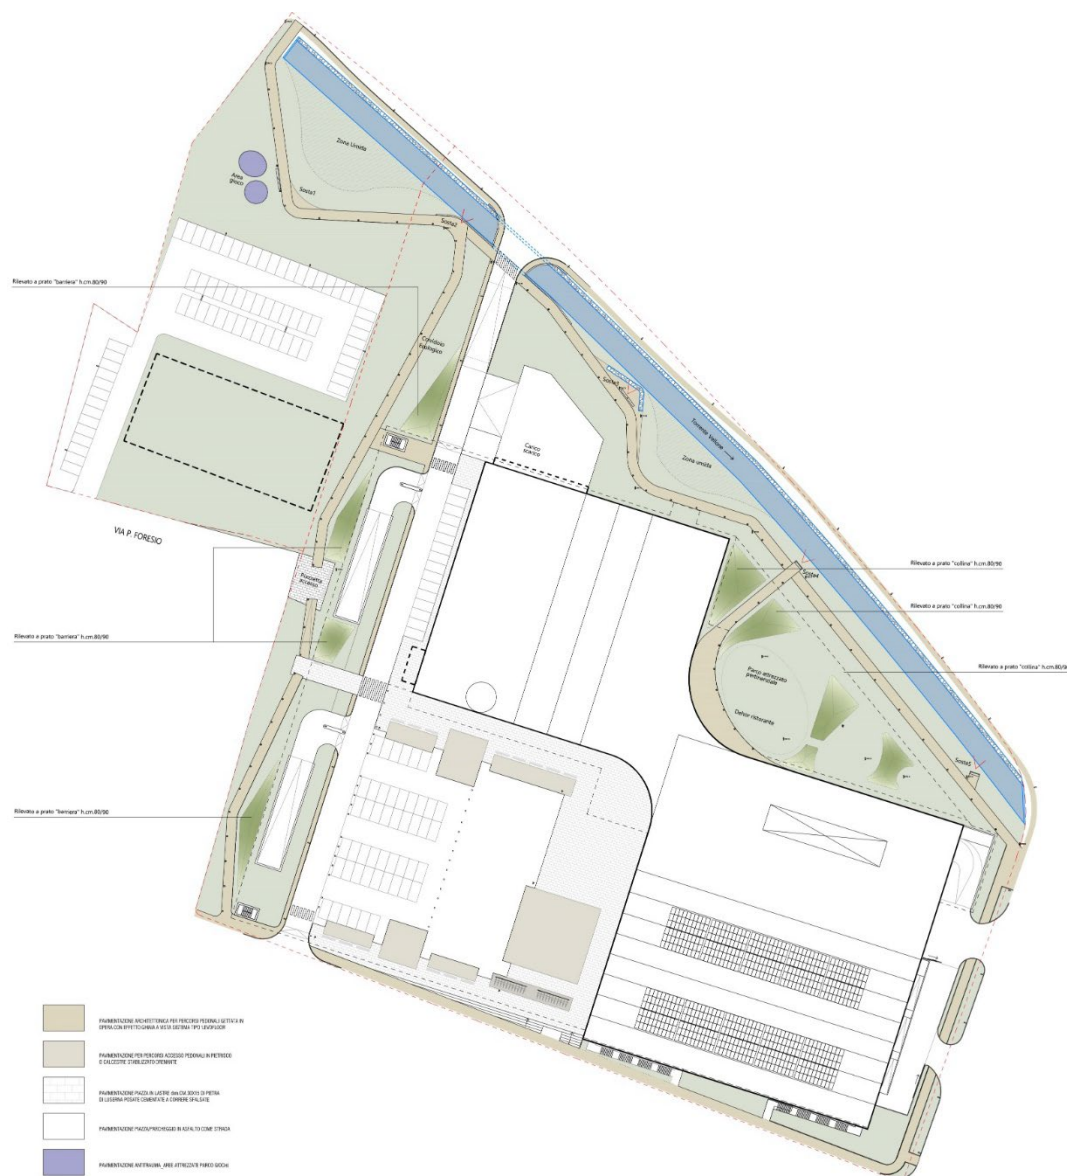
Planimetria dei percorsi ciclopedonali e distribuzione dei rilevati di terra
